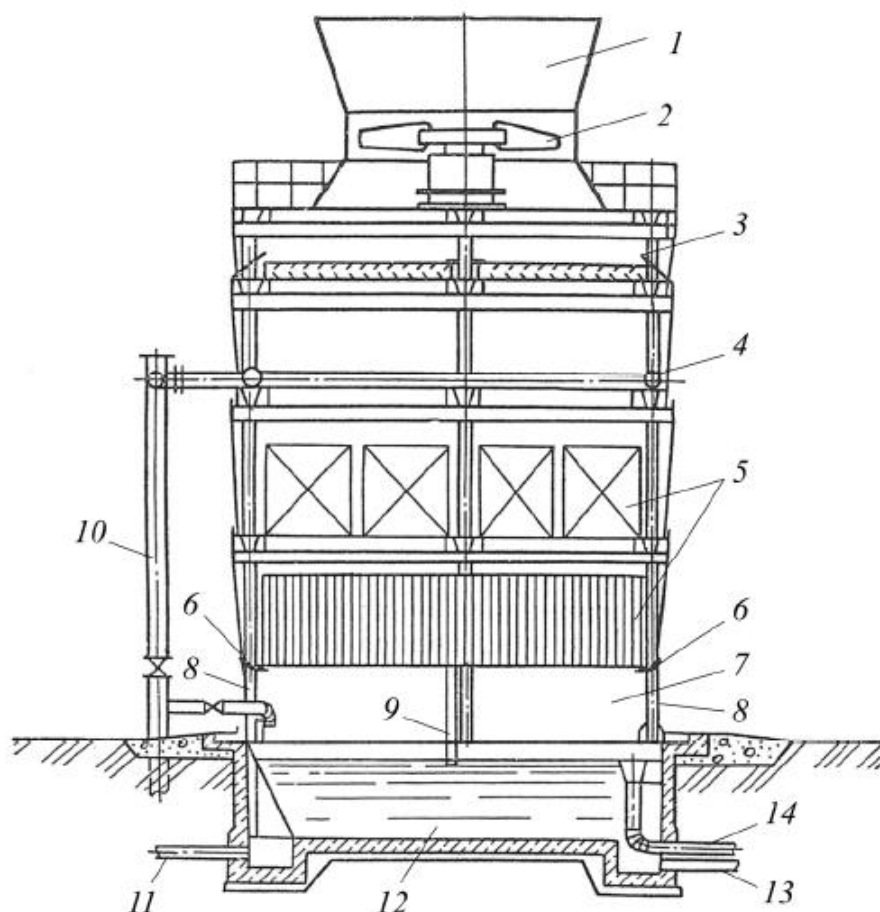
Схема вентиляторной градирни с отсасывающим вентилятором:
